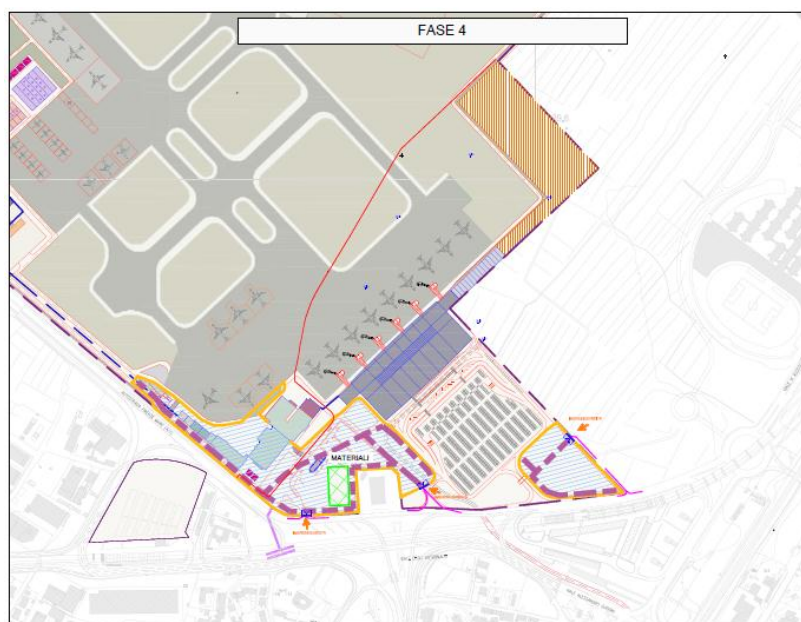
Cantierizzazione dell’Area Nuovo Terminal – Fase 4
